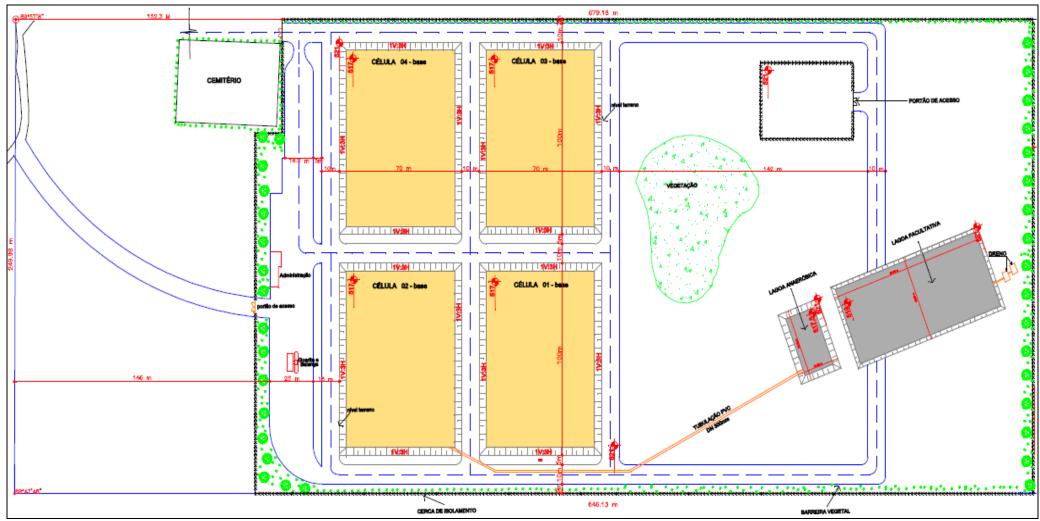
Imagem da Planta do Aterro Sanitário de Erechim.
